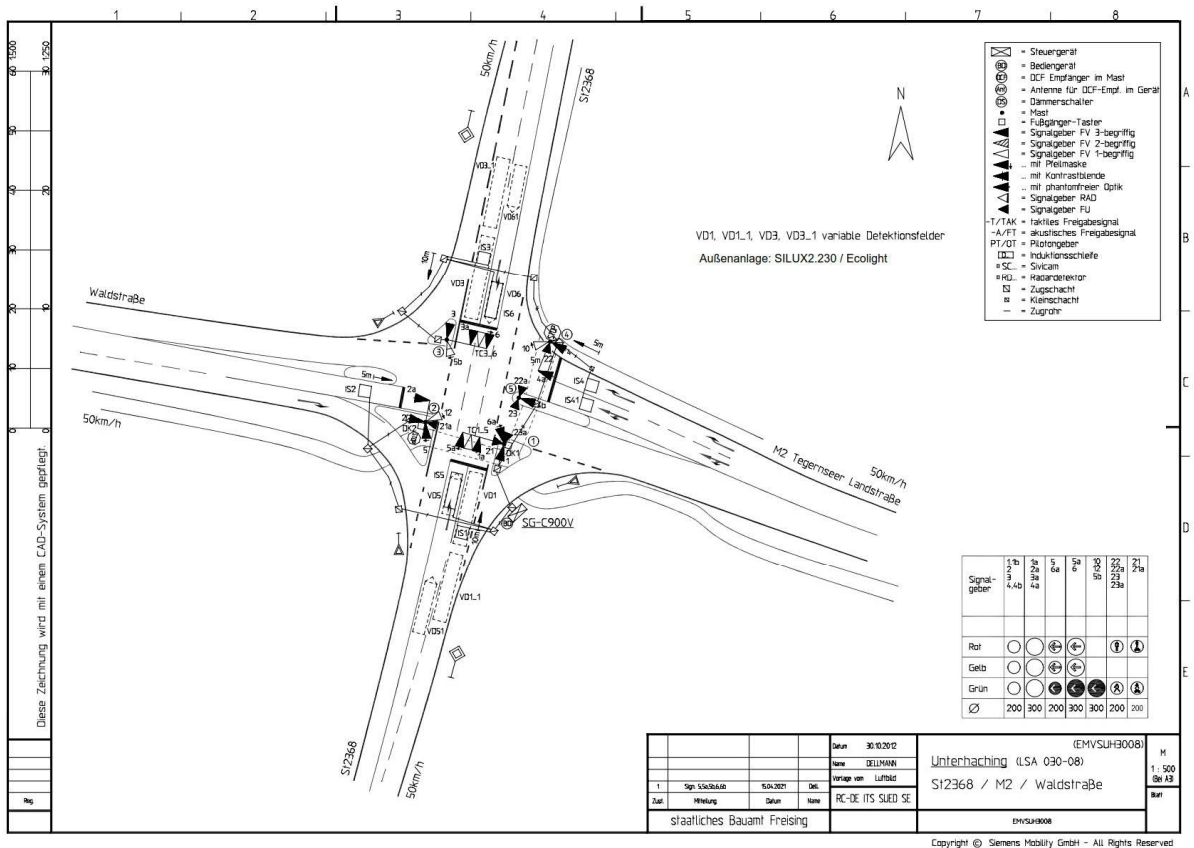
Lageplan signalisierter Knotenpunkt St2368/ M2/ Waldstraße St.-Martin-Straße/ Klammstraße (vom Staatlichen Bauamt Freising zur Verfügung gestellt)
